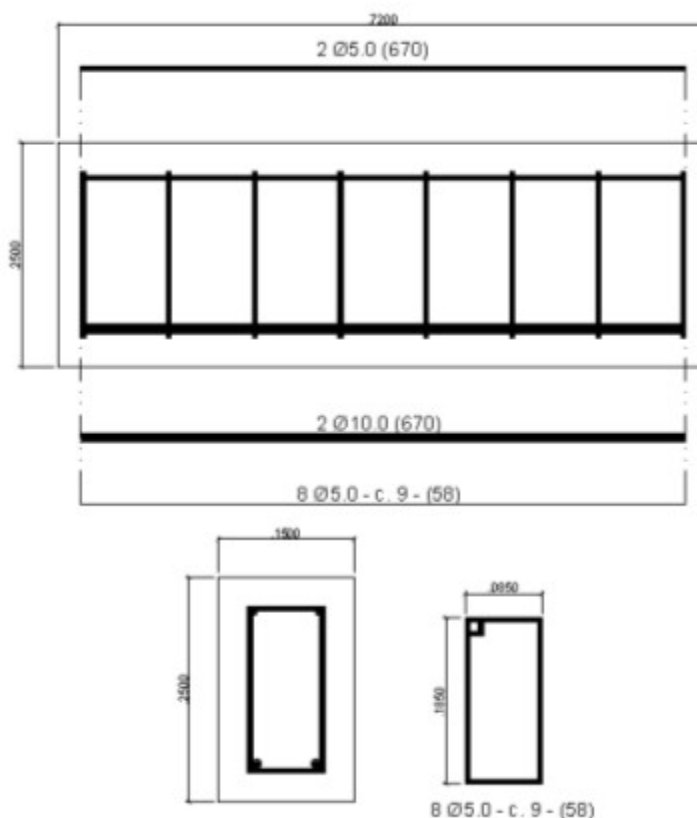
Exemplo de detalhe de armadura para o nível 0 de cobrimento
